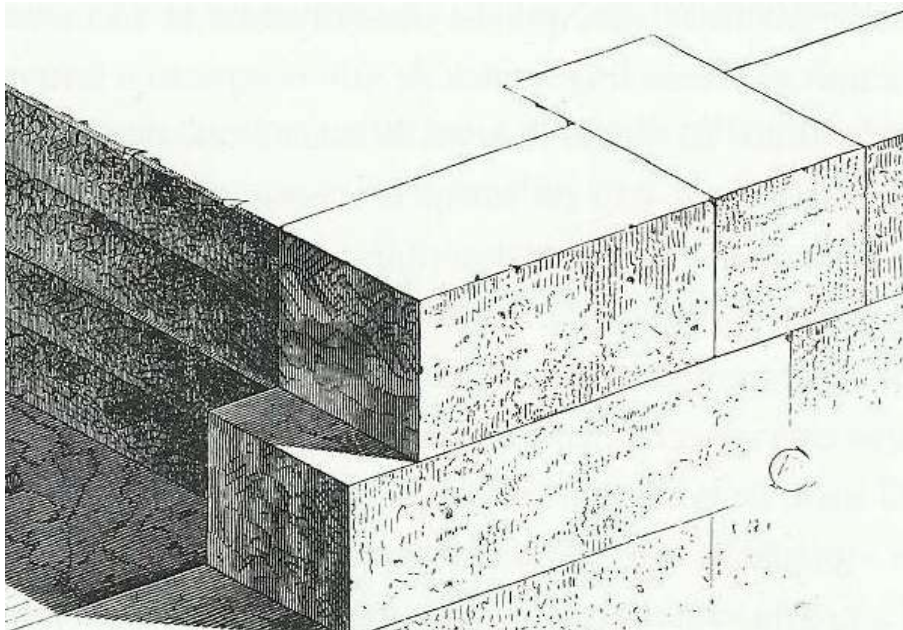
Detalle del relleno del núcleo de hormigón apisonado de un muro de sillares. (Imagen 1 en Choisy (1999:11)).
